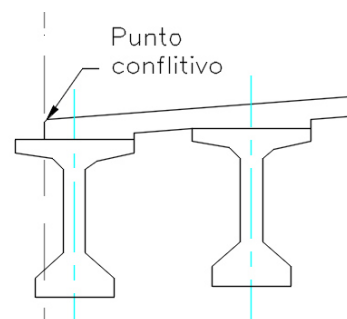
Proyecto original. Vigas sobresalen de la estructura.
